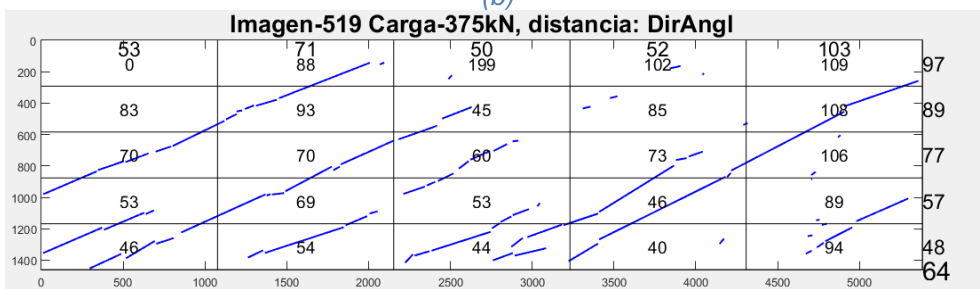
Patrón de Fisuras Viga I24I-Ciclo 3.
